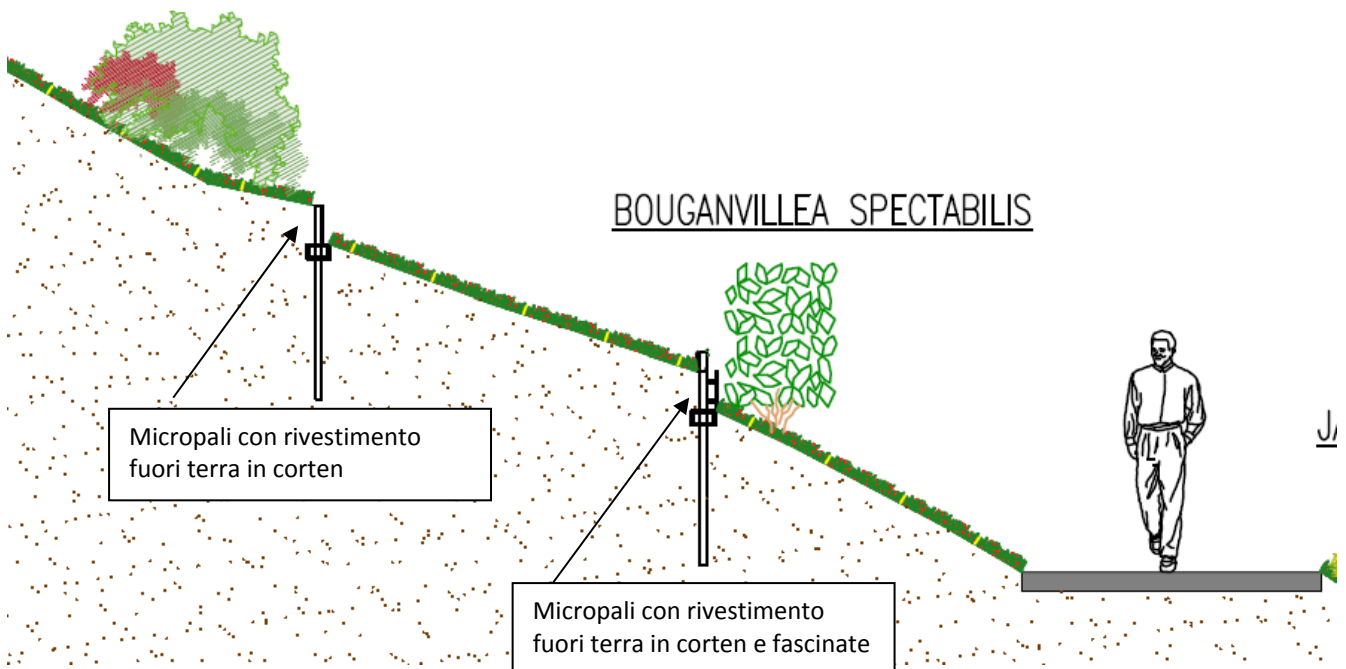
Sezione tipo con sistema di contenimento e mitigazione visiva
